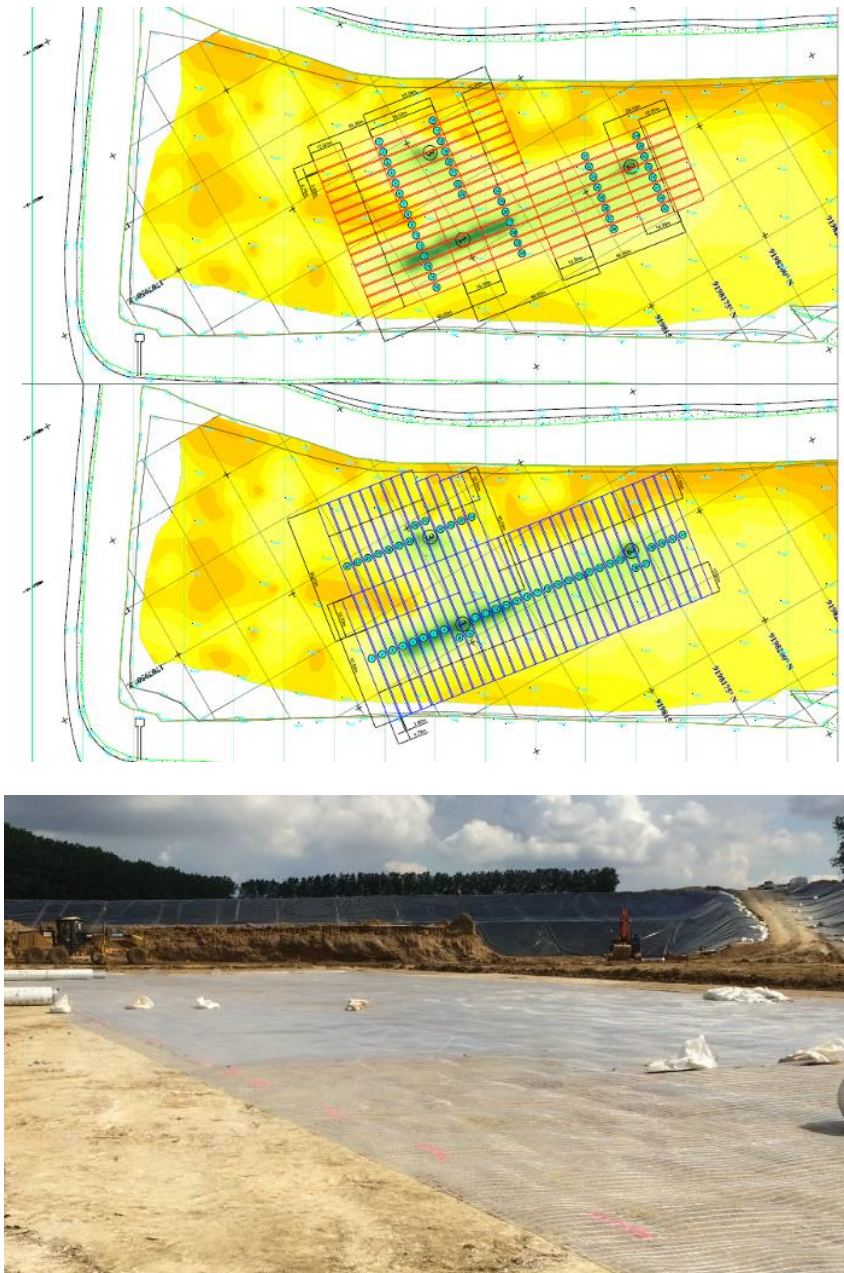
Plan de calepinage de la géogrille de renforcement en couches croisées et mise en œuvre du produit de renforcement
